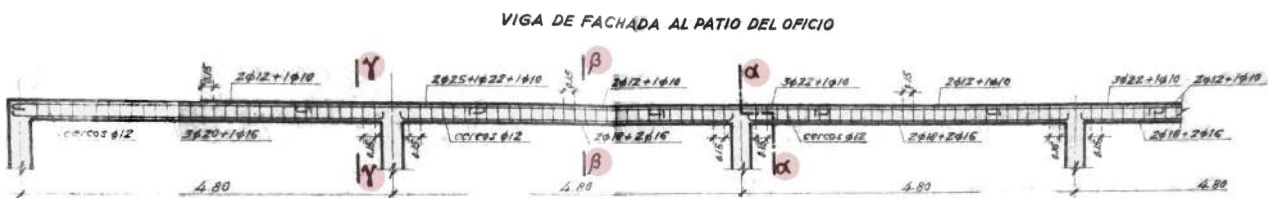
VIGA DE FACHADA AL PATIO DE OFICIO
